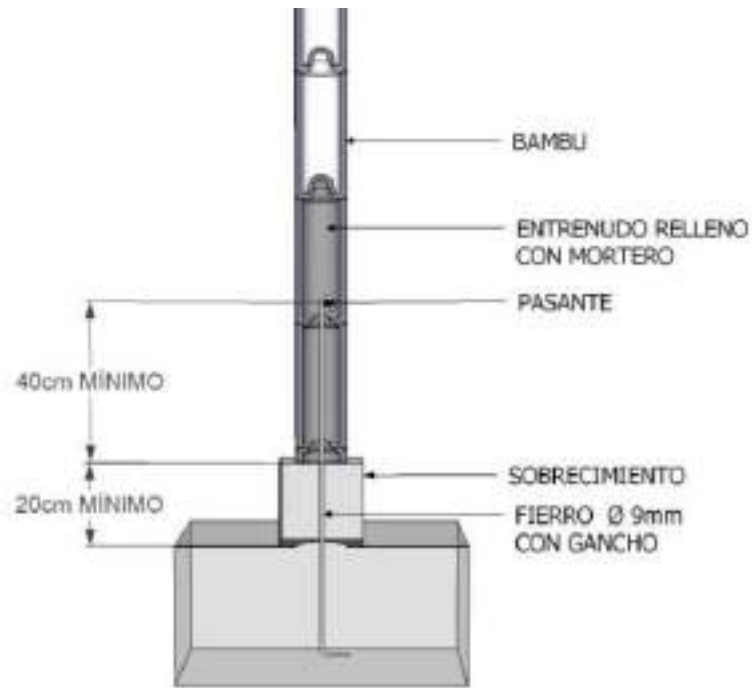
Detalle de conexión cimentación – columna. Norma E.100
